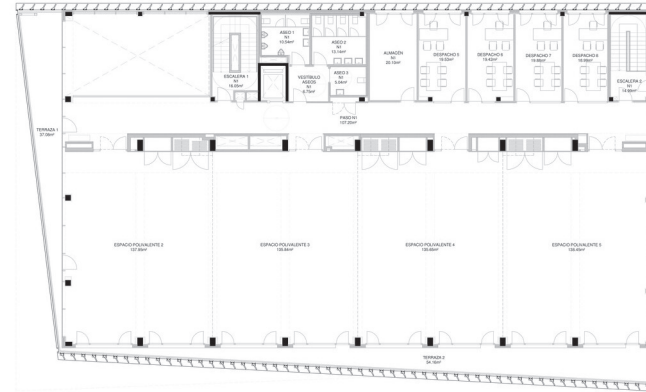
Planta Baja (Equi Estudio + Bieme Arquitectura, 2022)
